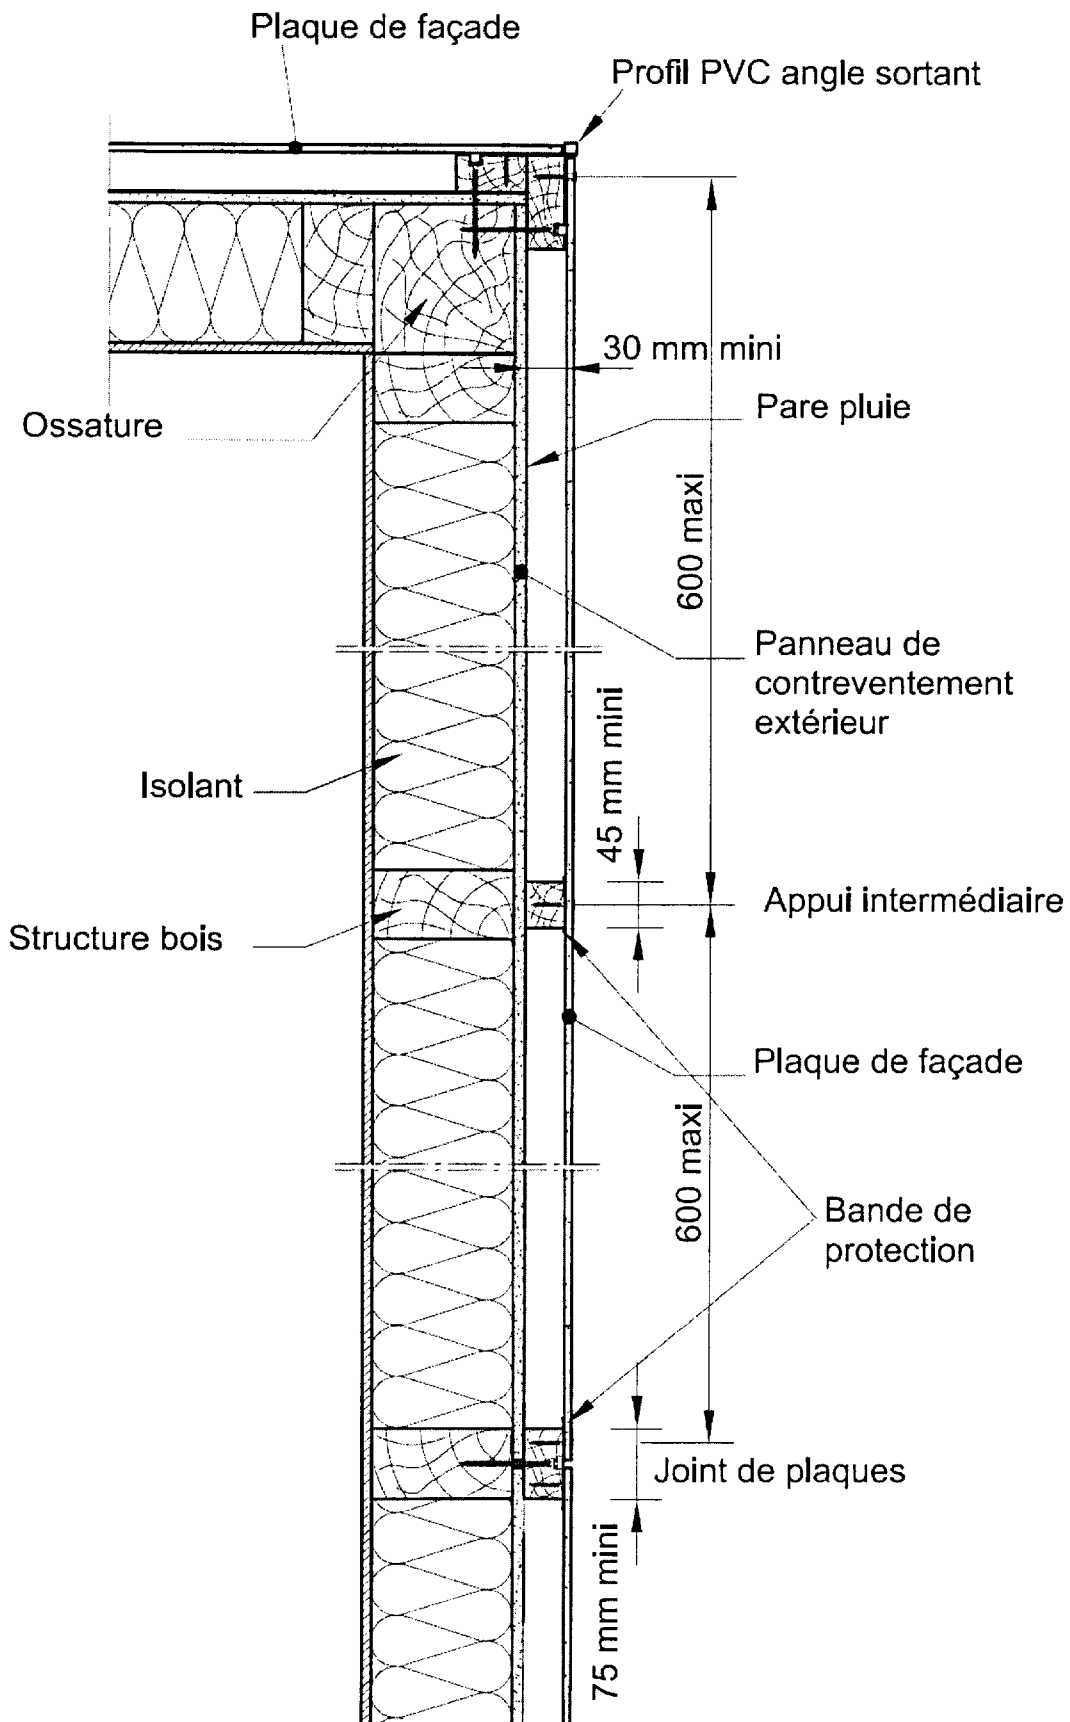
Pose sur bâtiments à ossature bois – Plan coupe de principe
